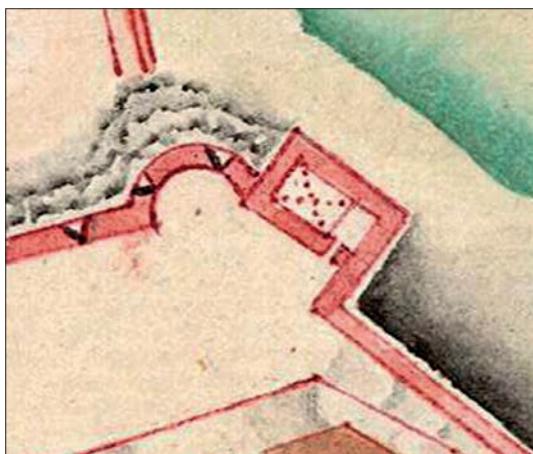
DETALLE DE LA PLANTA DEL REPUESTO DE PÓLVORA DE LA BATERÍA REAL, EN UN PLANO DE MELILLA DE 1735. Archivo General de Simancas, MPD-60-053.
